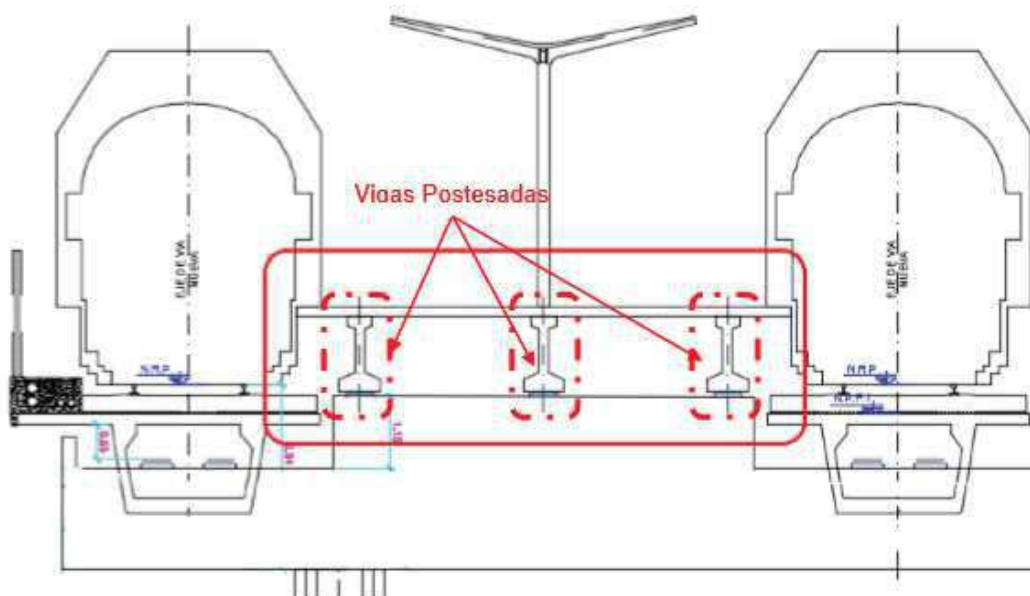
Sección Andén estación Paternal del Puente ferroviario.
